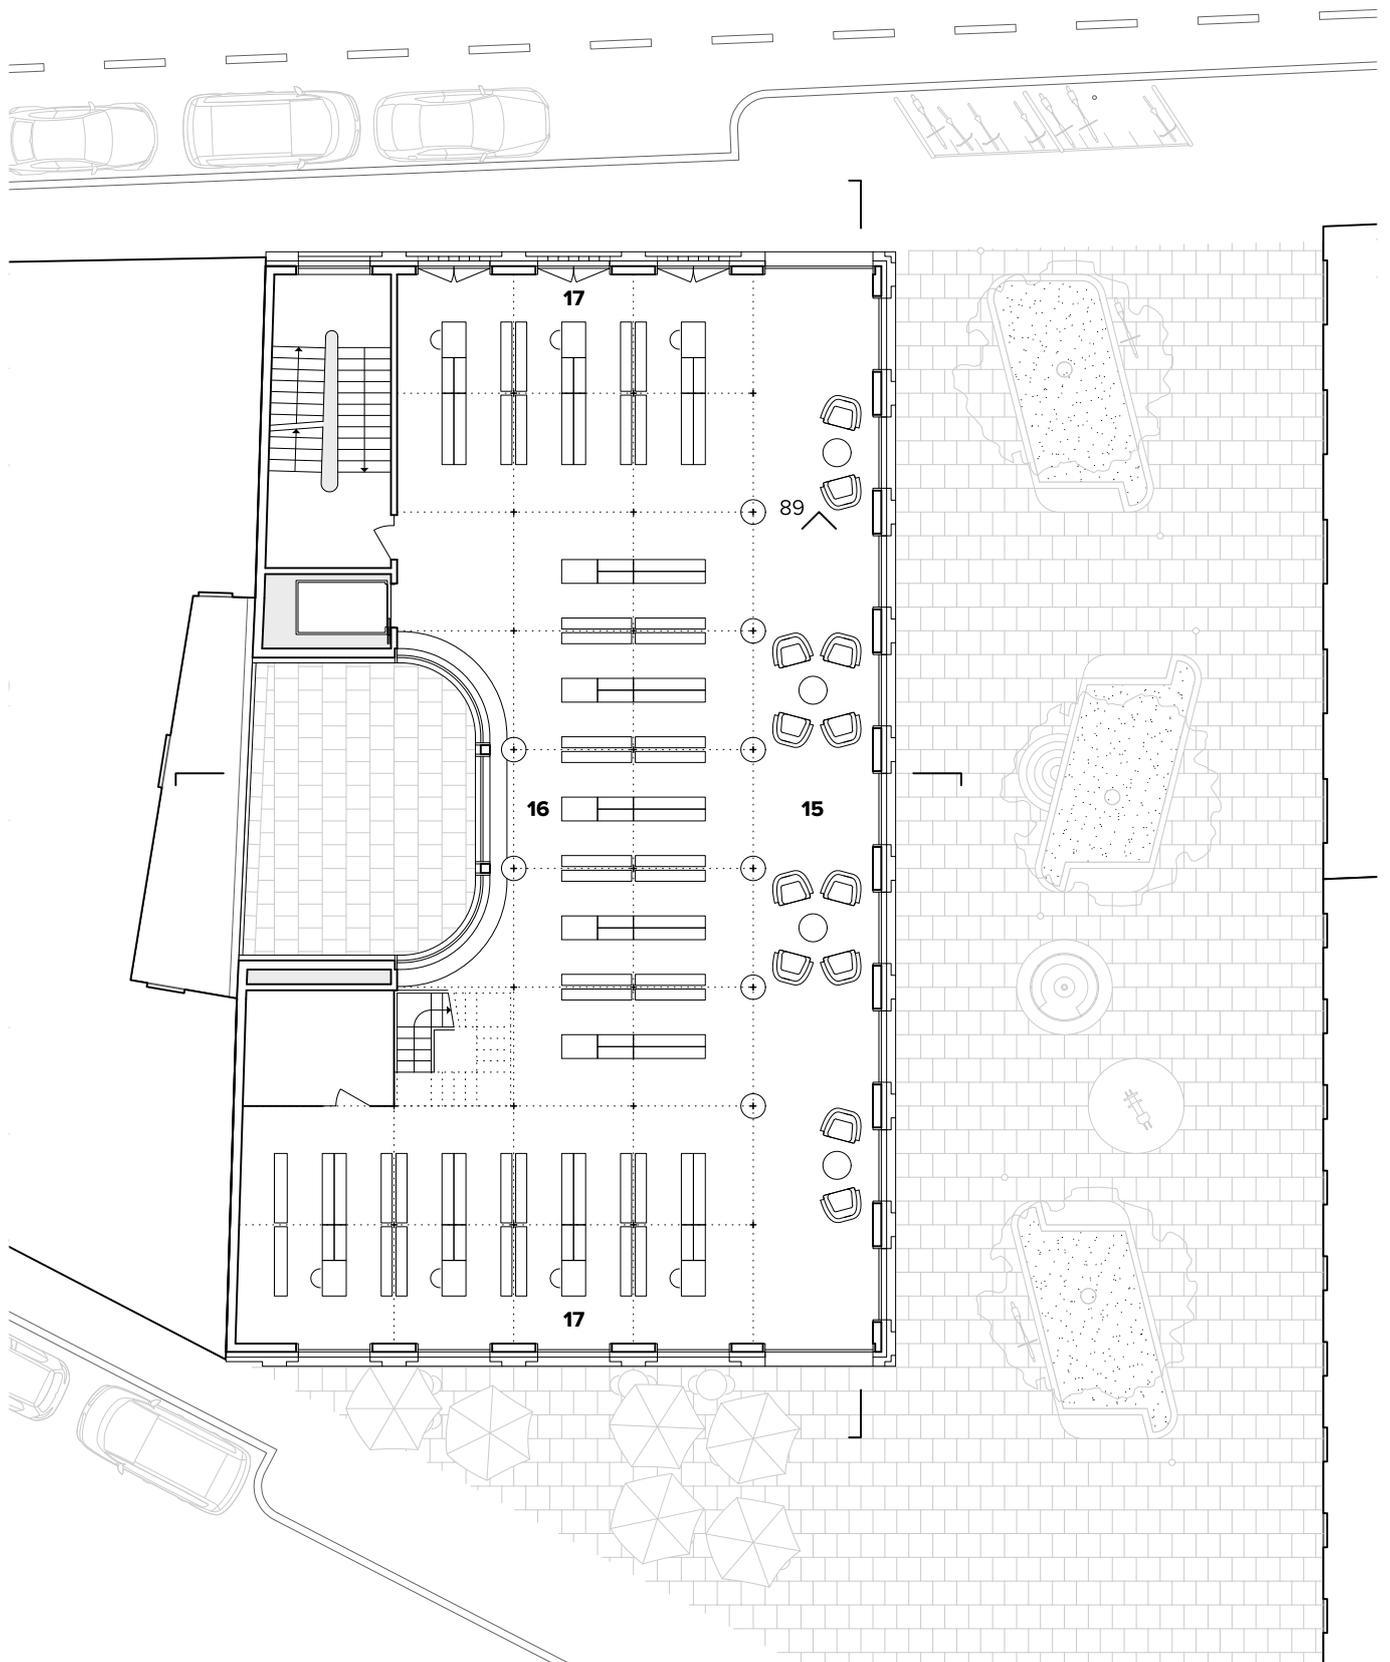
Grundriss 3. Obergeschoss 1.200 (BM)
